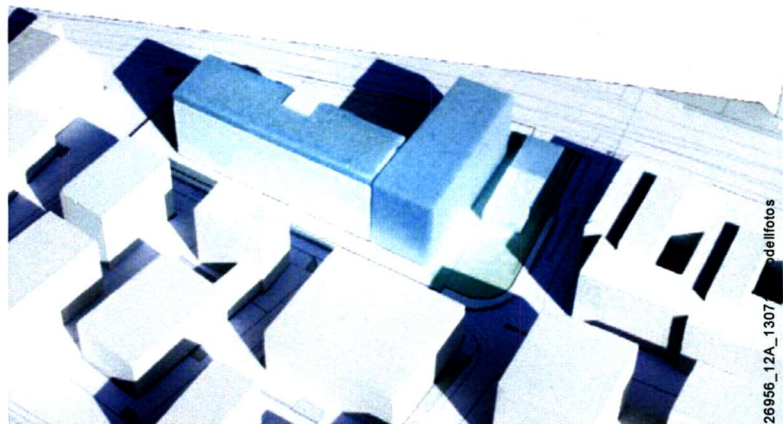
Anbau direkt an das bestehende Gebäude angebaut (Modellfotografie)
